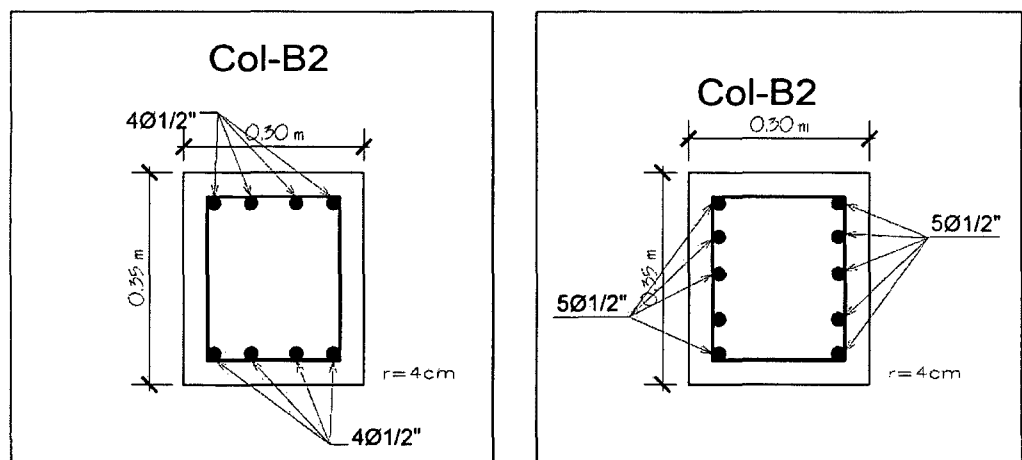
Distribución de refuerzo en cada uno de los lados de la columna B2.
